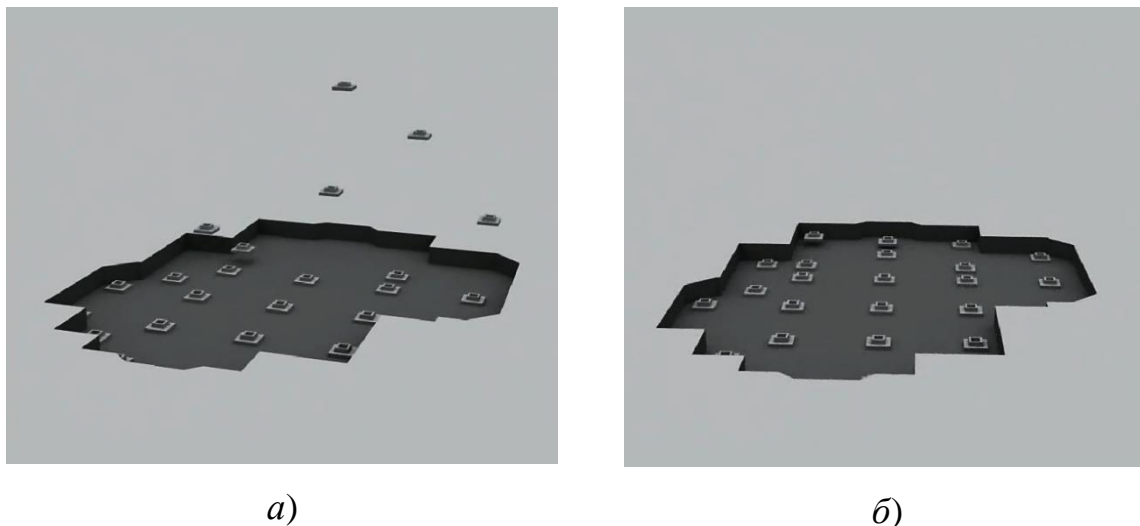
Монтаж окремо розташованих фундаментів:
